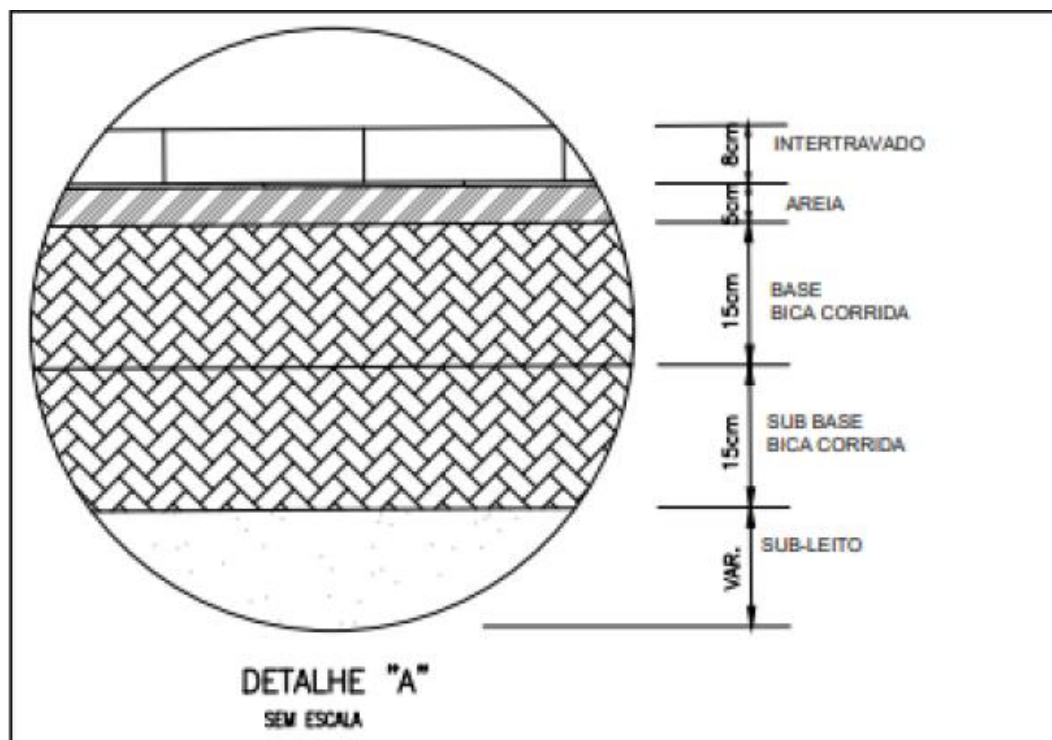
Detalhamento da Seção Tipo - Estacionamento
